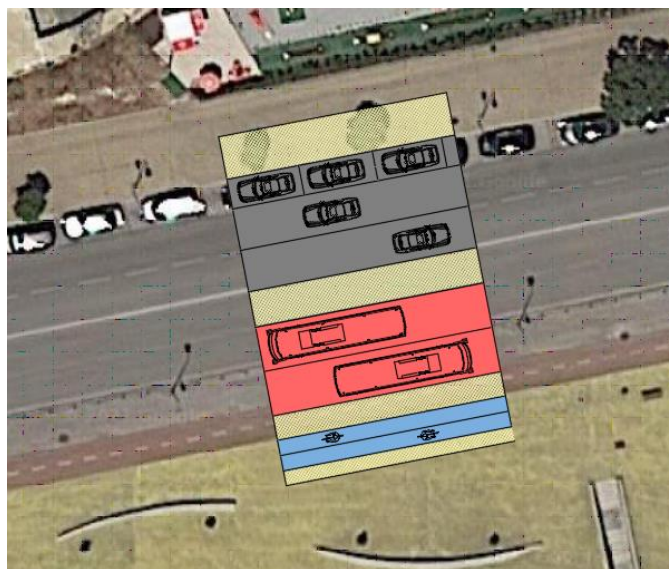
Proposta para reformulação da Av. Espanha – trecho 4
